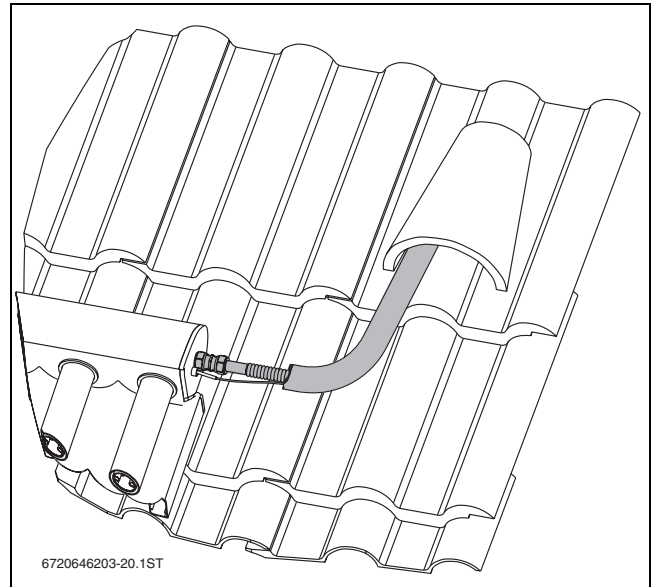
Montiertes Anschlussrohr und Durchführung durch das Dach
